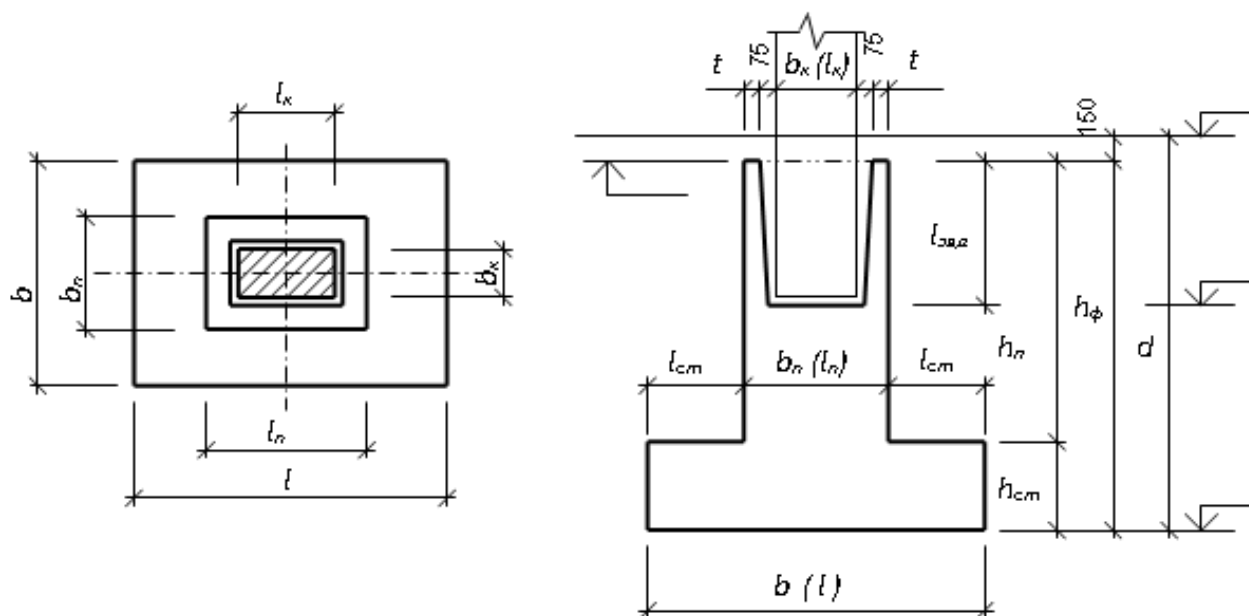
До конструювання окремого монолітного залізобетонного фундаменту під збірну залізобетонну колону
